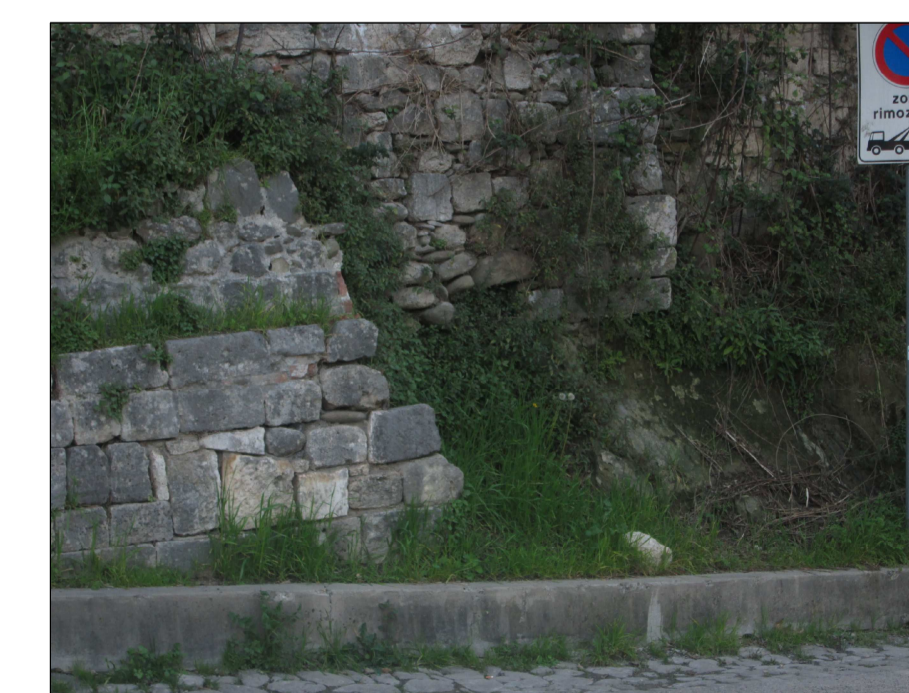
La foto mostra un particolare del prospetto Est del muro; dalla foto risulta evidente come un tratto della fondazione del muro risulta non poggiante sul basamento roccioso.
